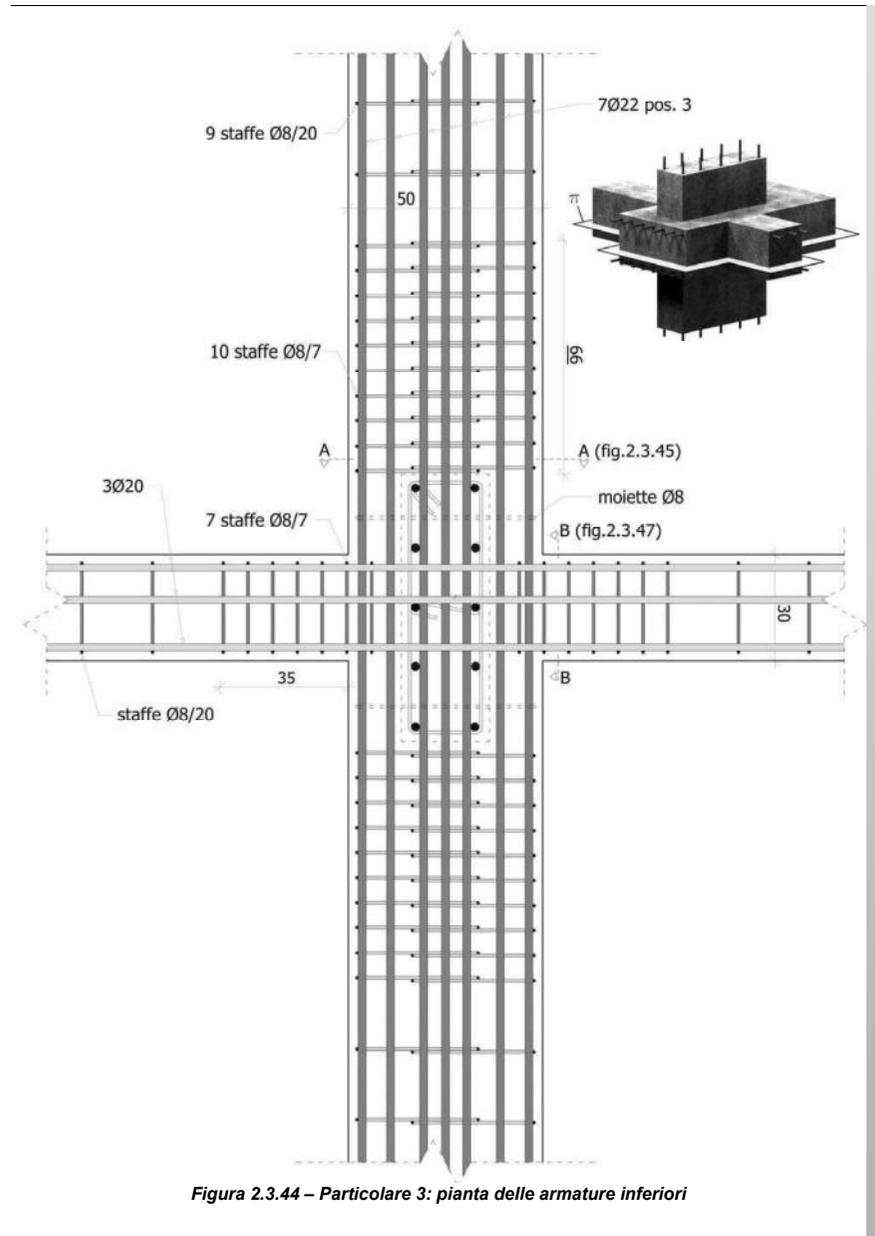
Particolare 3: pianta delle armature inferiori
